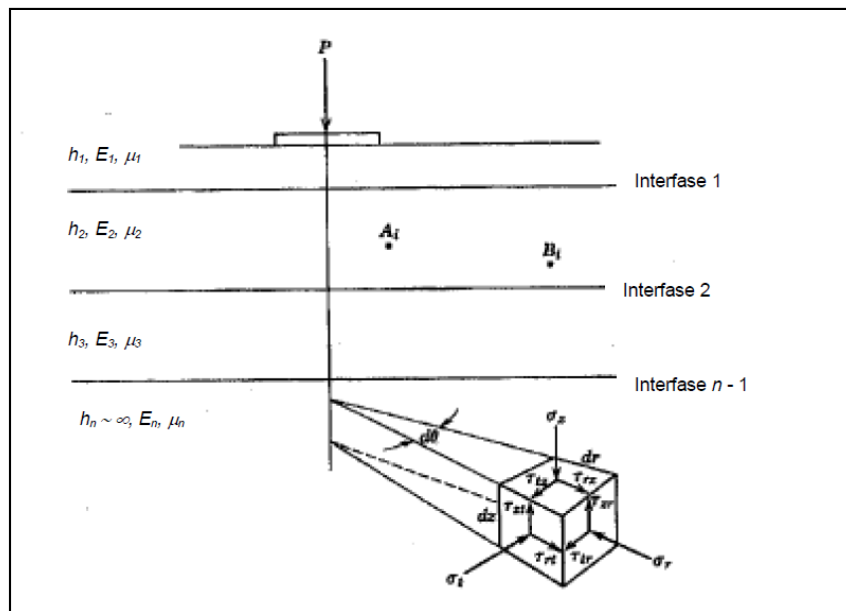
Diagrama del modelo estructural de un pavimento flexible.
